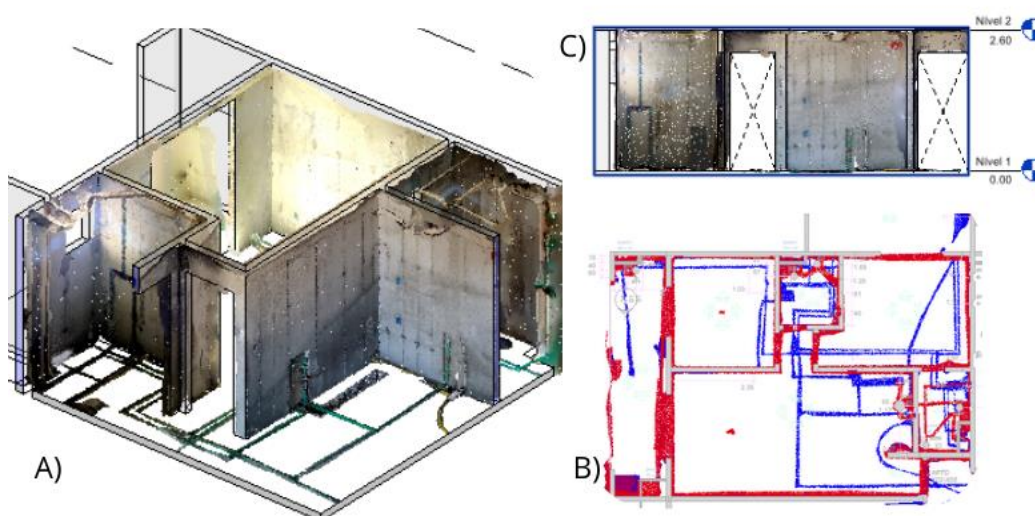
A) Reconstrução do modelo BIM B) Planta Baixa, funções de visibilidade; C) Elevação interna. Fonte: Autodesk Revit, 2023.
